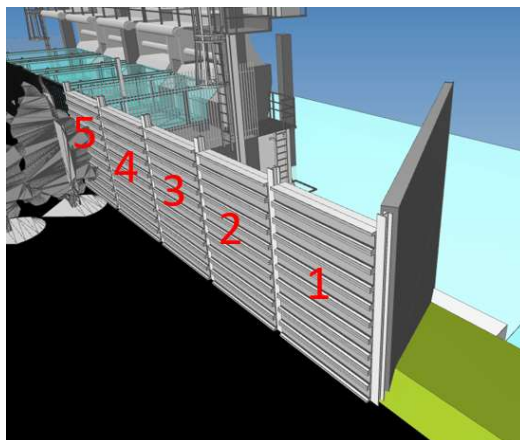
Plan 3D des panneaux de déflecteur amovible
